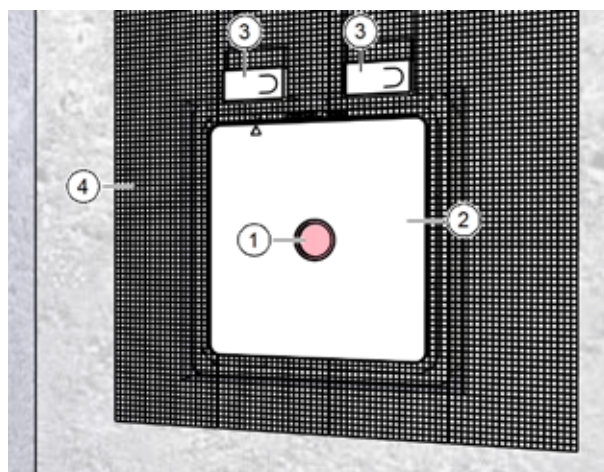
Intonacatura della cassetta a muro nell'area interna
